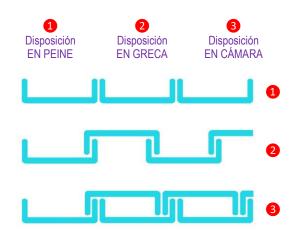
Vista en planta de las tres formas características de disponer los perfiles de vidrio en U.
